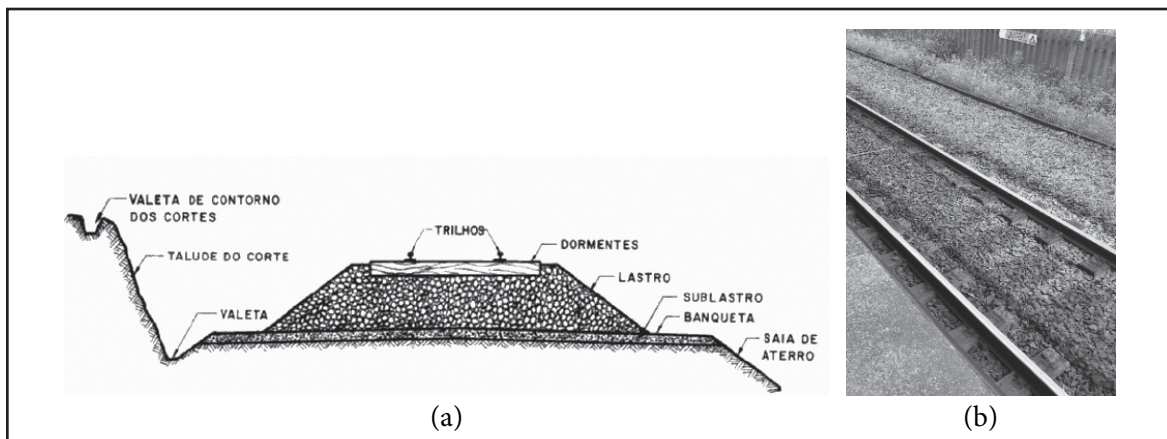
Vista em corte (a) e foto da via férrea superficial terrestre (b)
